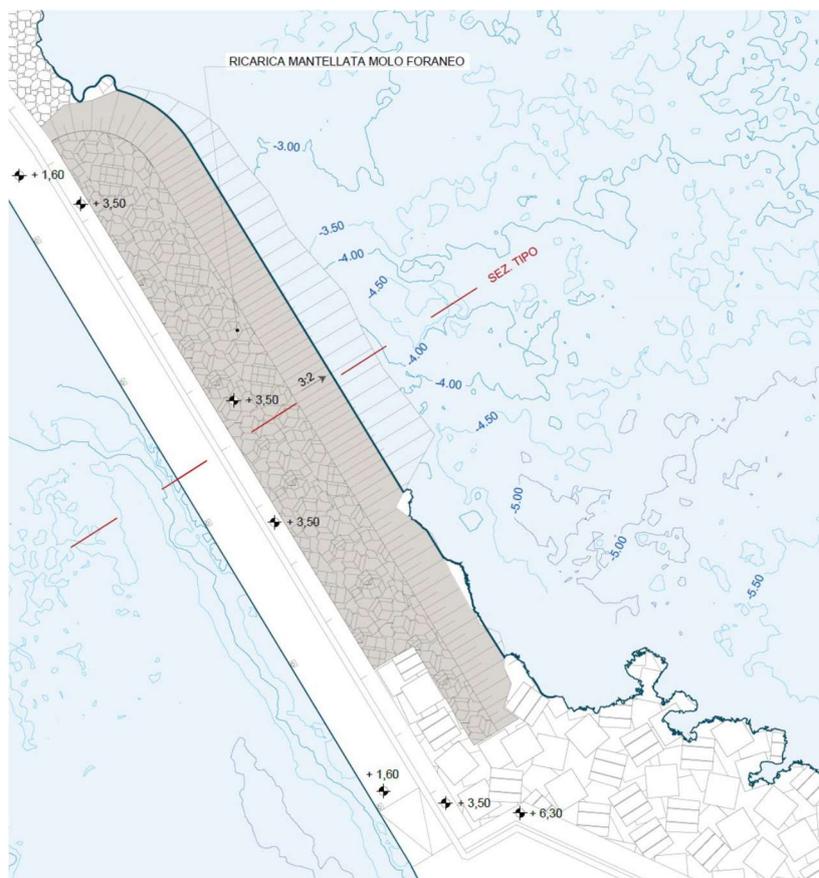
Stralcio planimetria ricarica mantellata del molo esistente
